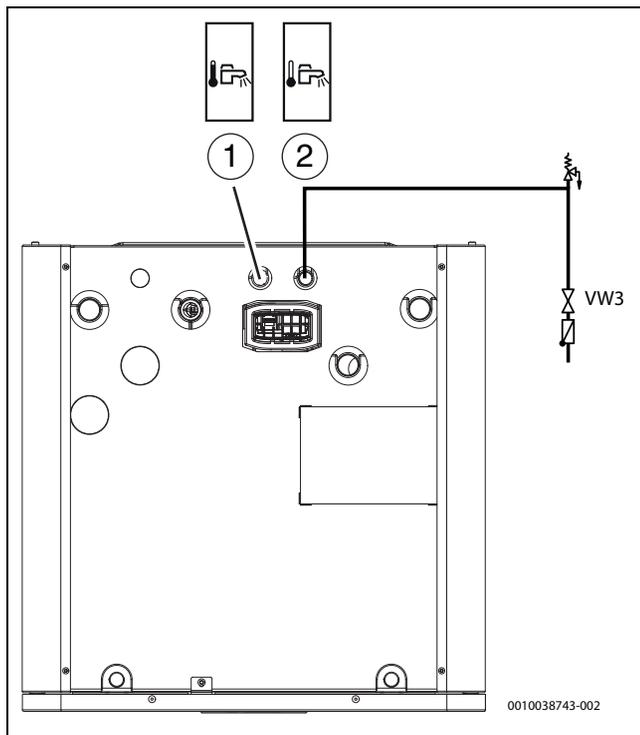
Acqua del rubinetto collegamenti pompa di calore
